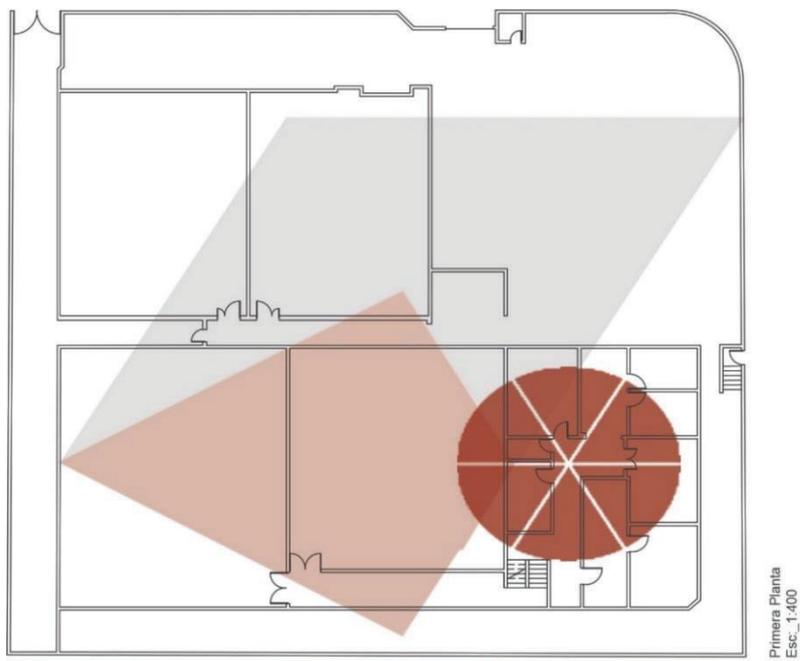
Partido Arquitectónico aplicado en Plantas del BNE.
